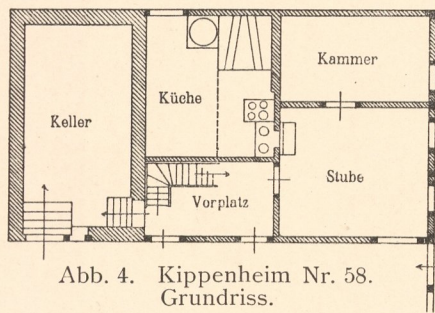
Kippenheim Nr. 58. Grundriss.
